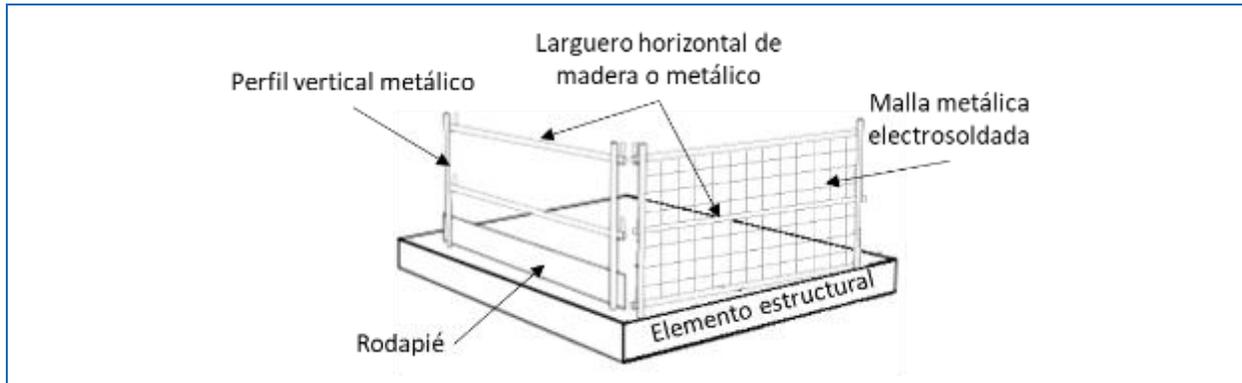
Componentes y partes barandas del tipo modular – Elaboración Propia
